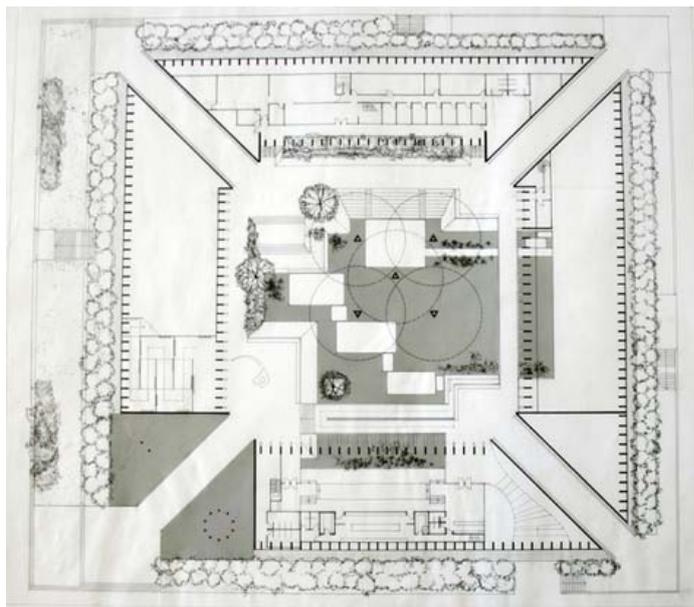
Planta baixa do pavilhão do Canadá em Osaka, 1970. Segunda etapa do concurso. Fonte: Canadian Architectural Archives
